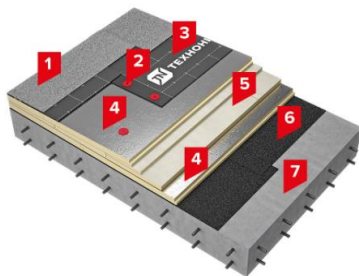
Кровельная система с теплоизоляционным слоем из пенополиизоцианурата ТН-кровля фикс бетон PIR
